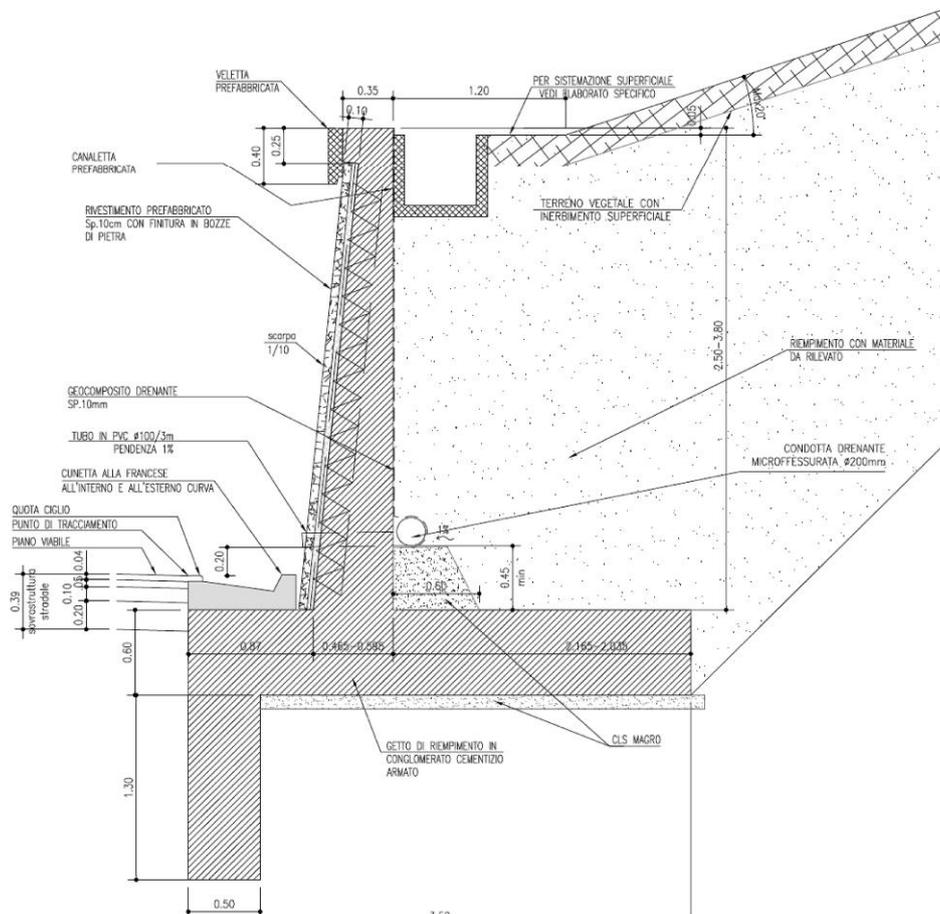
Sezione trasversale muro di controripa in frana MC202
